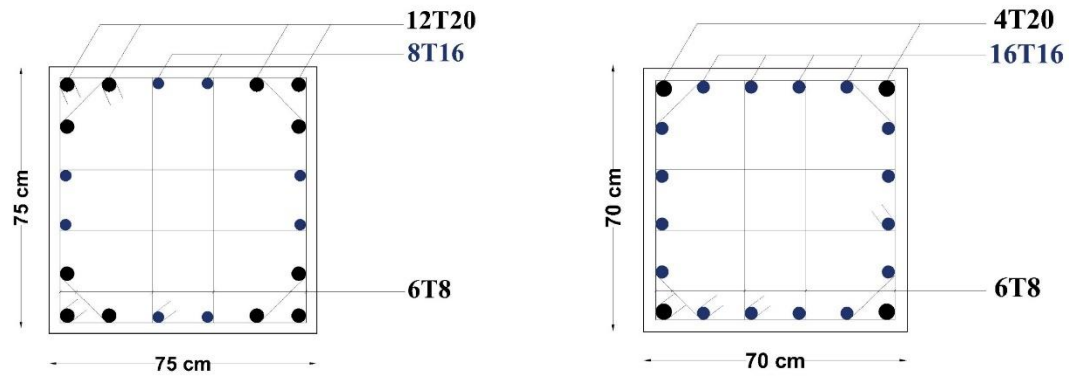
Schéma de ferrailage des poteaux (75x75) et (70x70)
